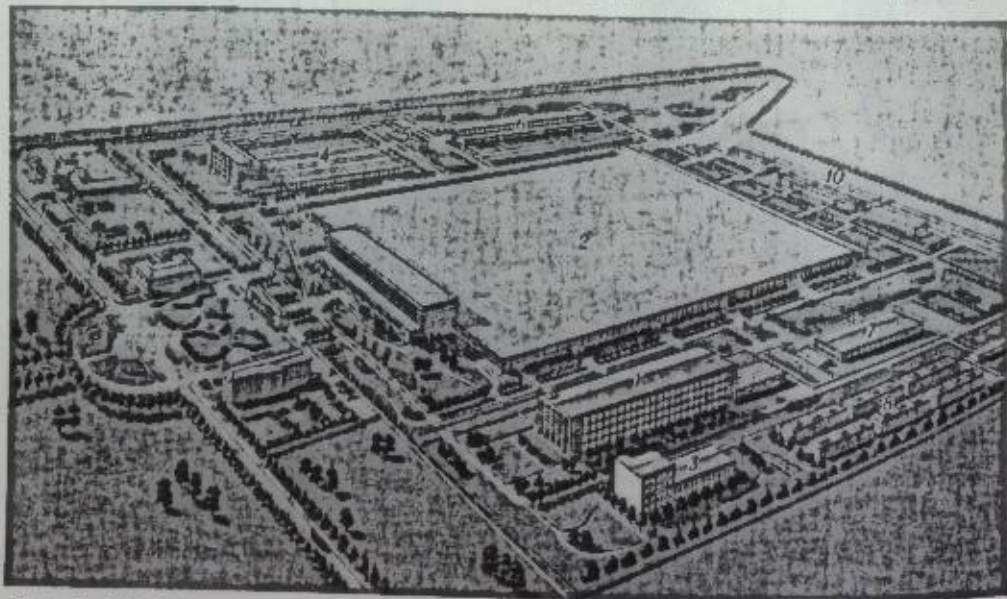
Завод капронового волокна: 1 — химич. цех; 2 — главный корпус; 3 — цех регенерации капролактама; 4 — опытное произ-во; 5 — центр. лаборатория; 6 — блок ремонтных цехов; 7 — машинно-компрессорная станция; 8 — градирни; 9 — водоумягчительная станция; 10 — склады.
